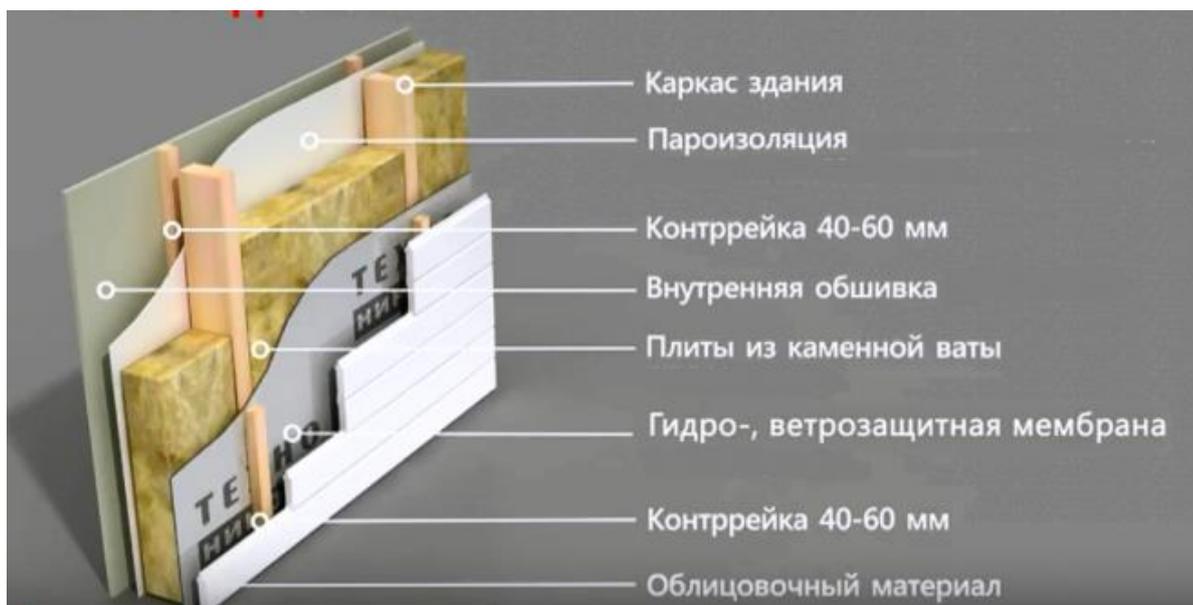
Конструкция теплоизоляции с минеральной ватой
